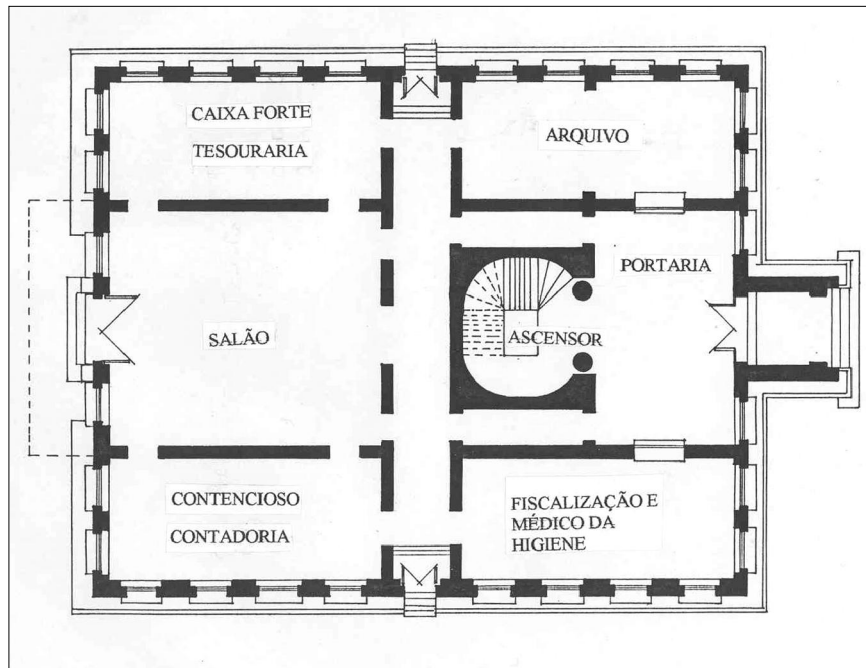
Paço Municipal. Planta Térreo. Levantamento arquitetônico – 1971.
